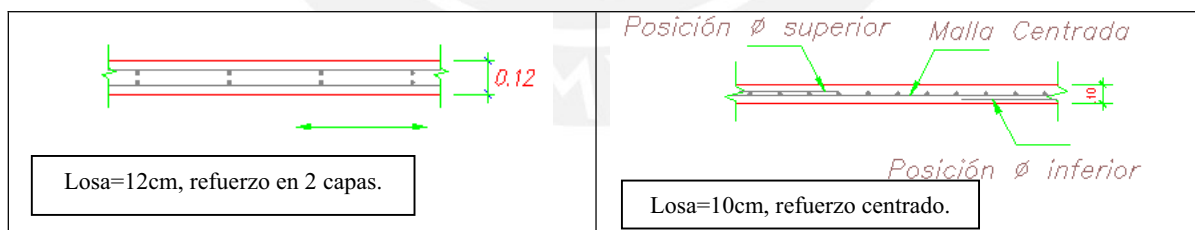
Empleo de Acero Corrugado como Refuerzo de Losa
